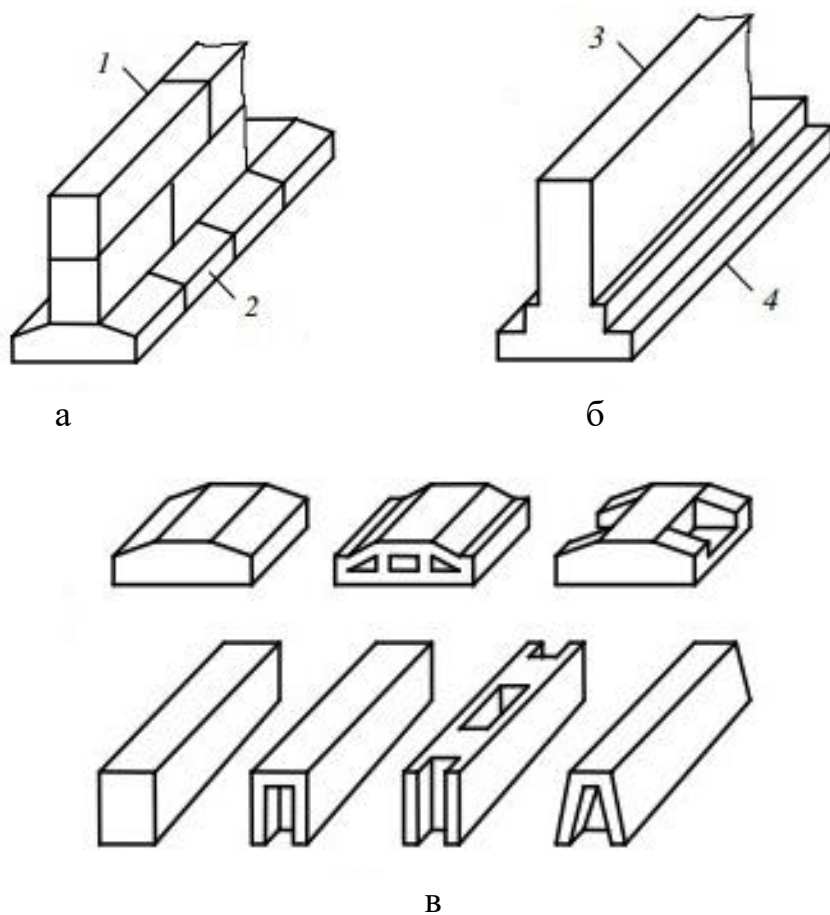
Стрічкові фундаменти: а – збірний безперевний;
